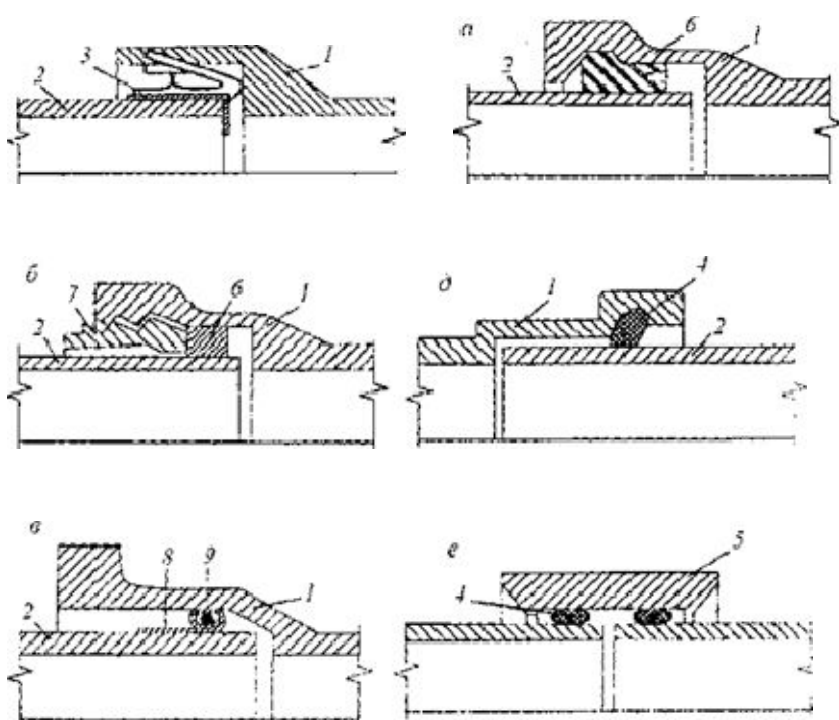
Стыковые соединения подземных трубопроводов:
